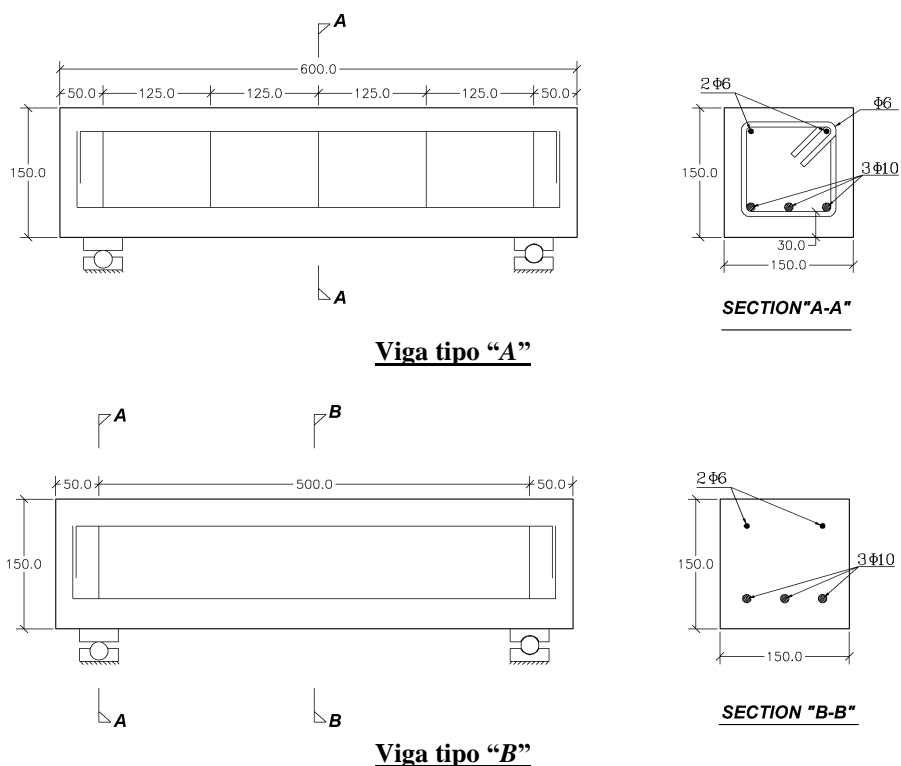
Geometria das vigas e detalhes das armaduras (dimensões em mm)
